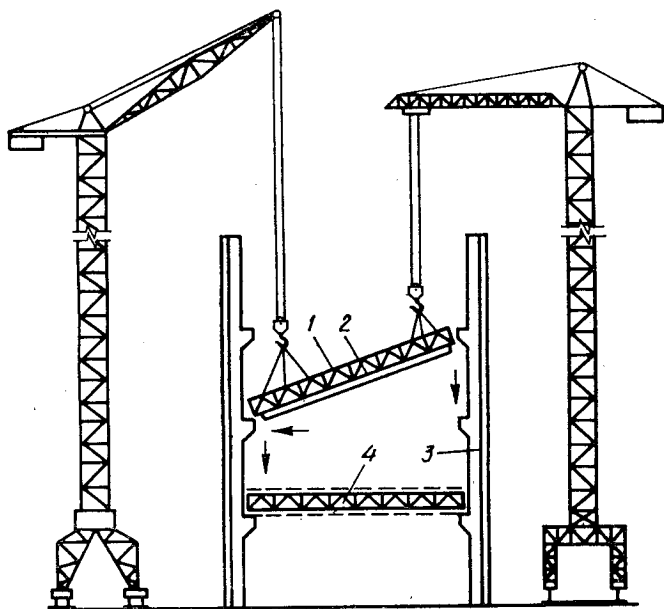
Монтаж тяжелых конструкций двумя башенными кранами:
